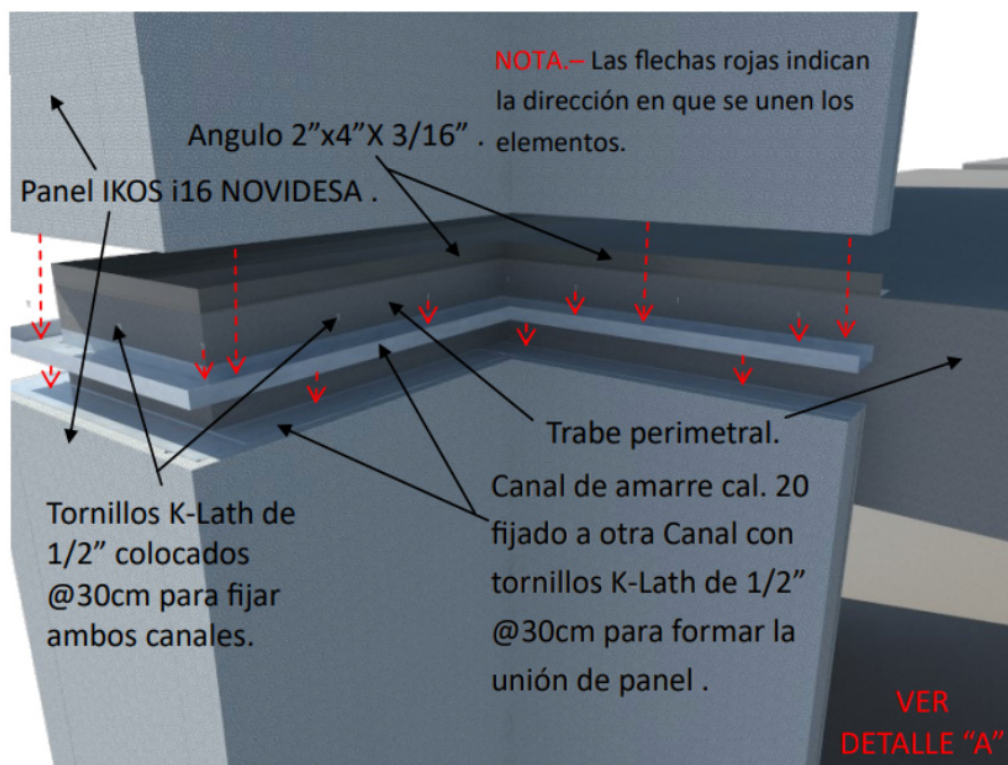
Vista exterior de elementos de fachada con paneles de poliestireno. (Elaboración propia)
